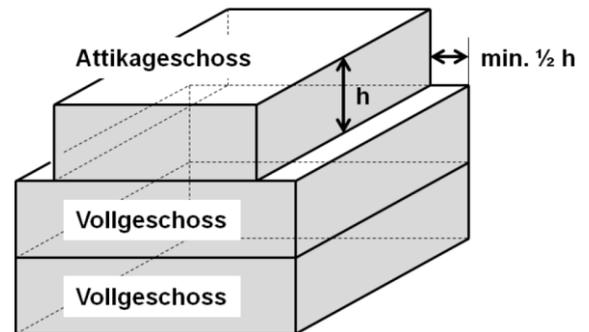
Attikageschoss (Quelle: kant. Leitfaden IVHB)
